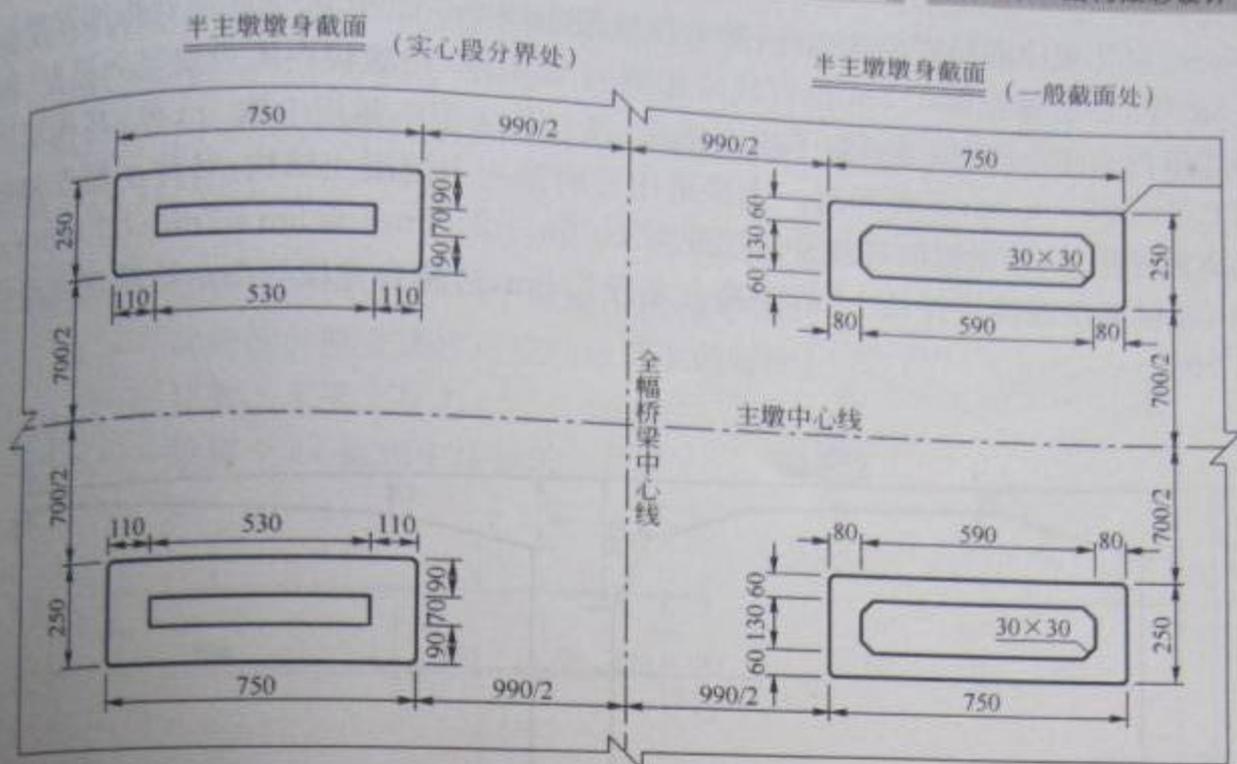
苏通大桥辅桥主墩截面(尺寸单位:cm)
